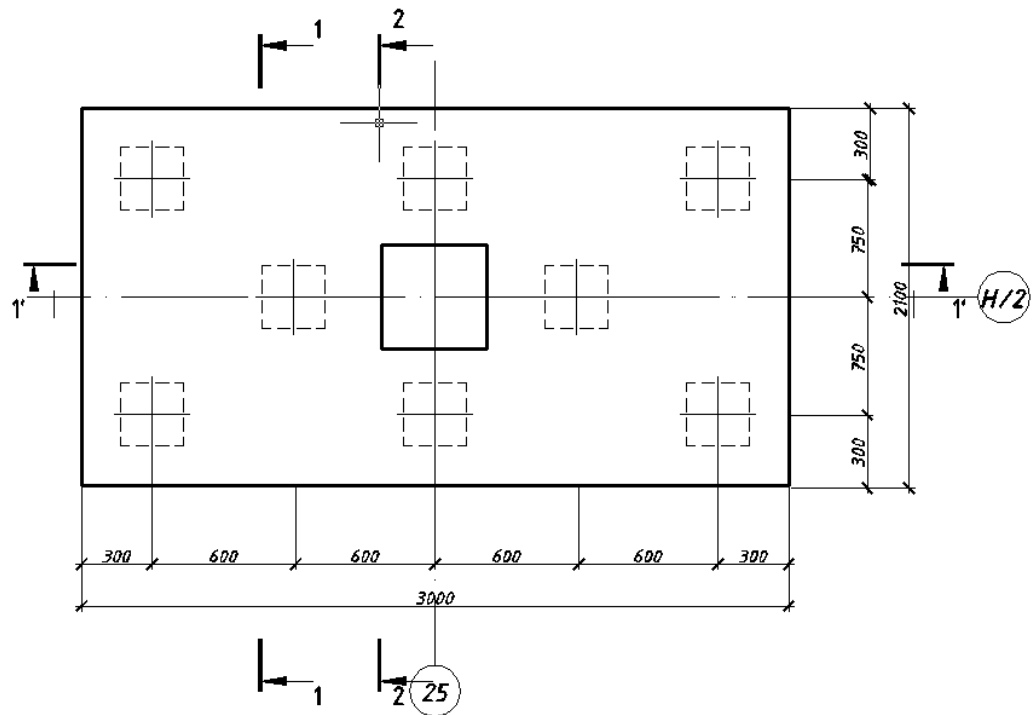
Схема к расчету арматуры плитной части фундамента
